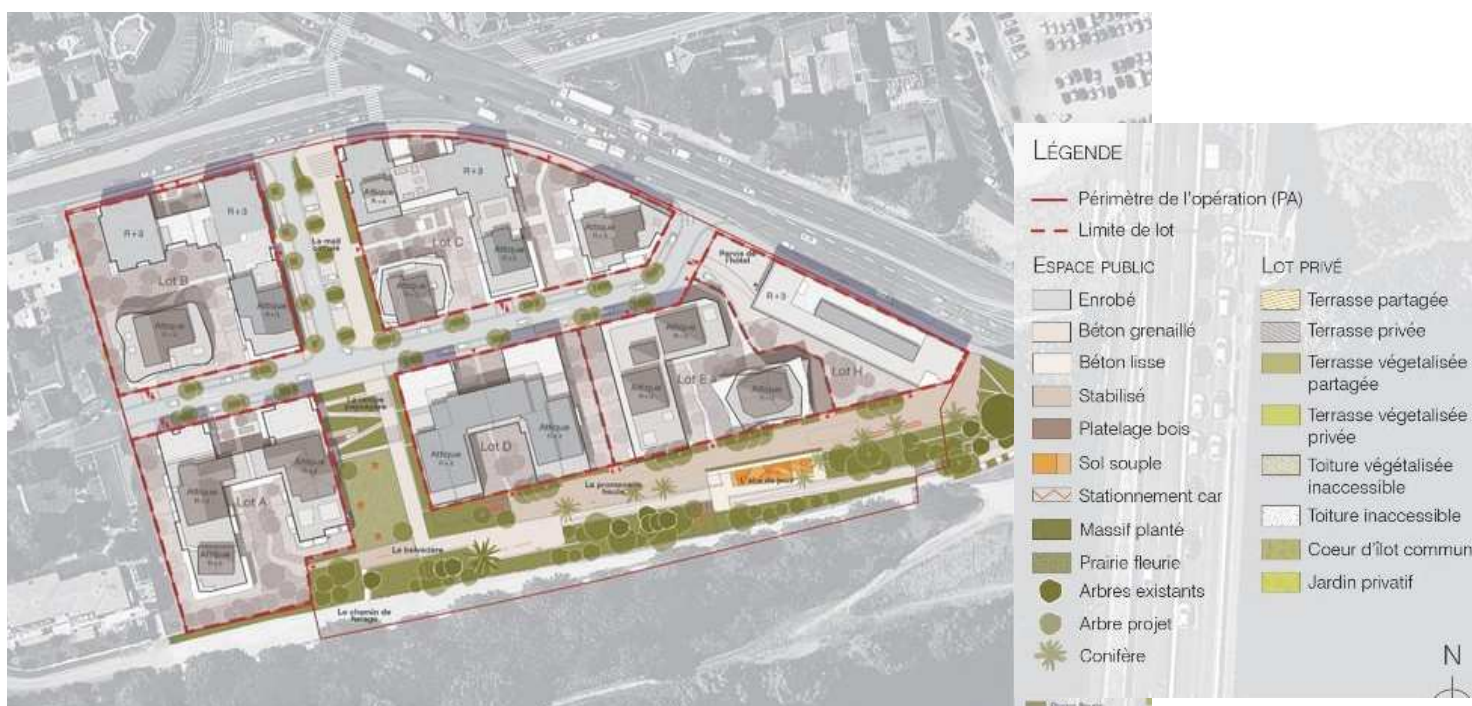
Plan masse du projet (Source : Étude d'impact, page 38)
